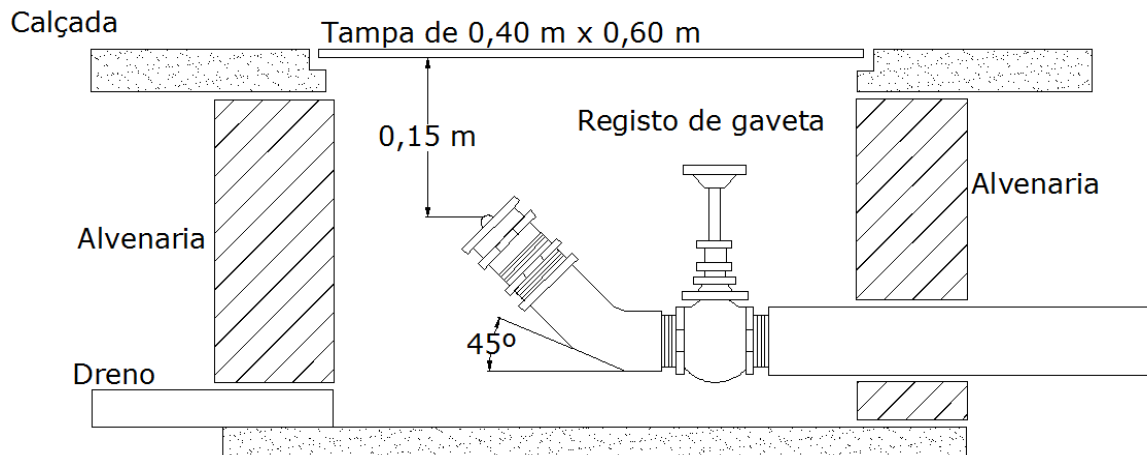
Hidrante de recalque na fachada ou muro da divisa
